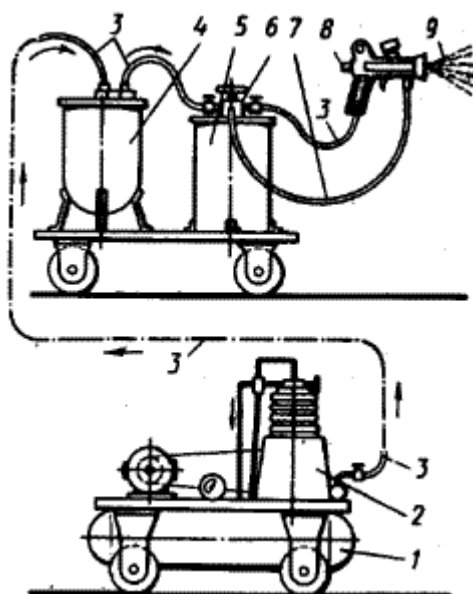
Компрессорный агрегат для нанесения грунтовки:
